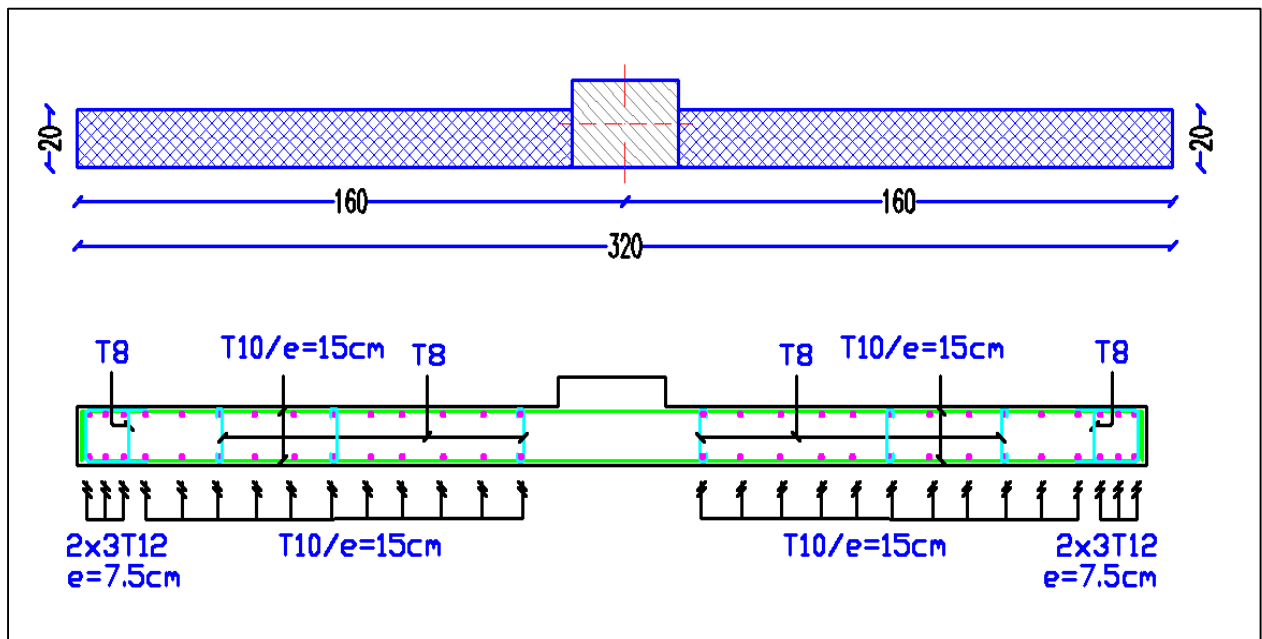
schéma de ferraillage des voiles sens (Y – Y)
